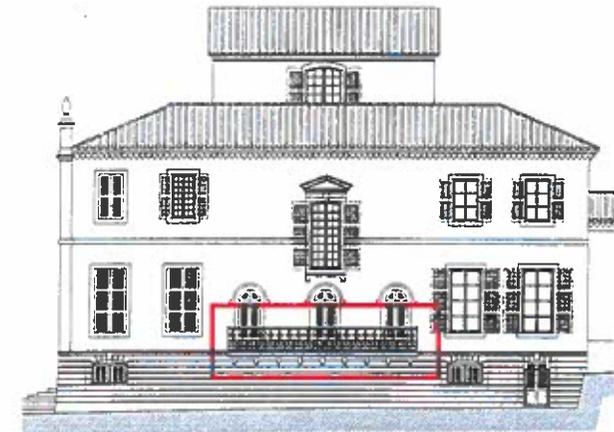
Façade Sud du corps principal, corbeaux du balcon à sonder
